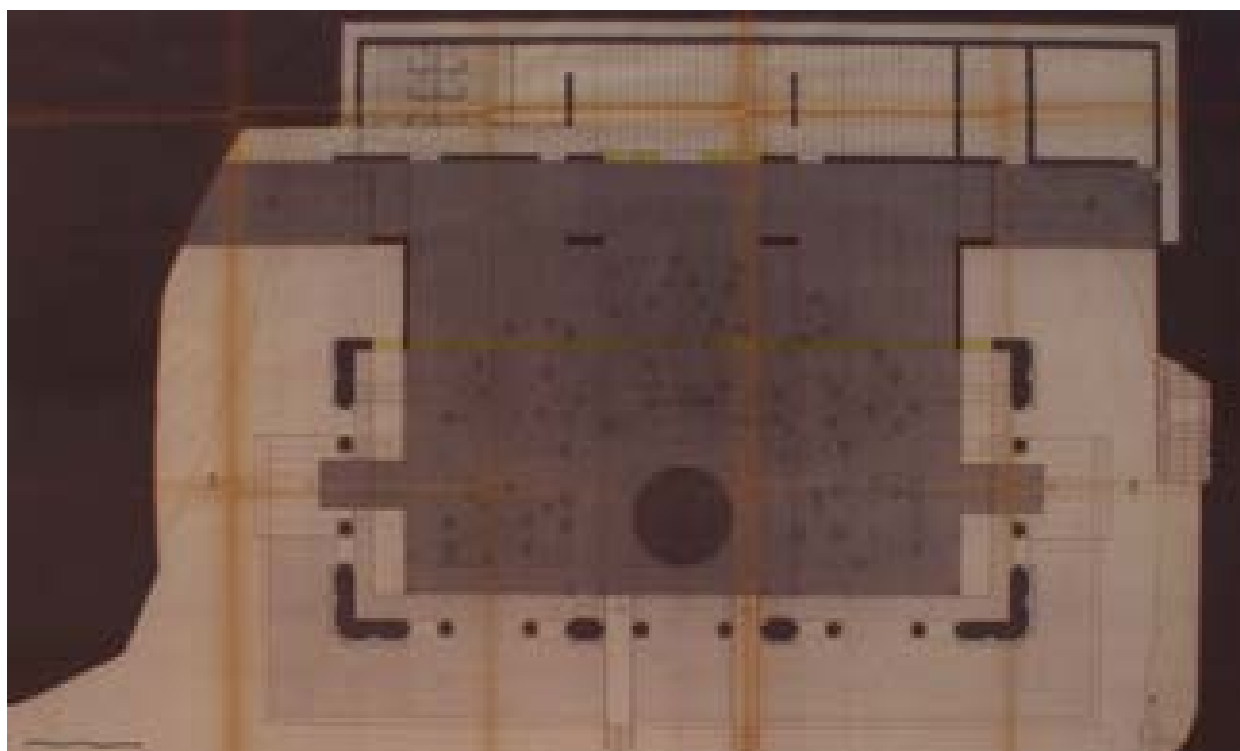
Planimetria del piano terra, stato sovrapposto - Progetto del 15/07/1985, agg. del 15/01/1987 (AABS-146)
